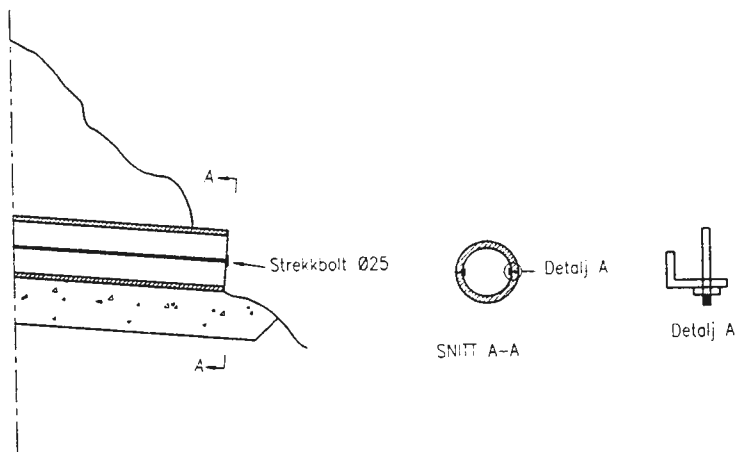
Ekstra stikkrenne i laveste punkt.
